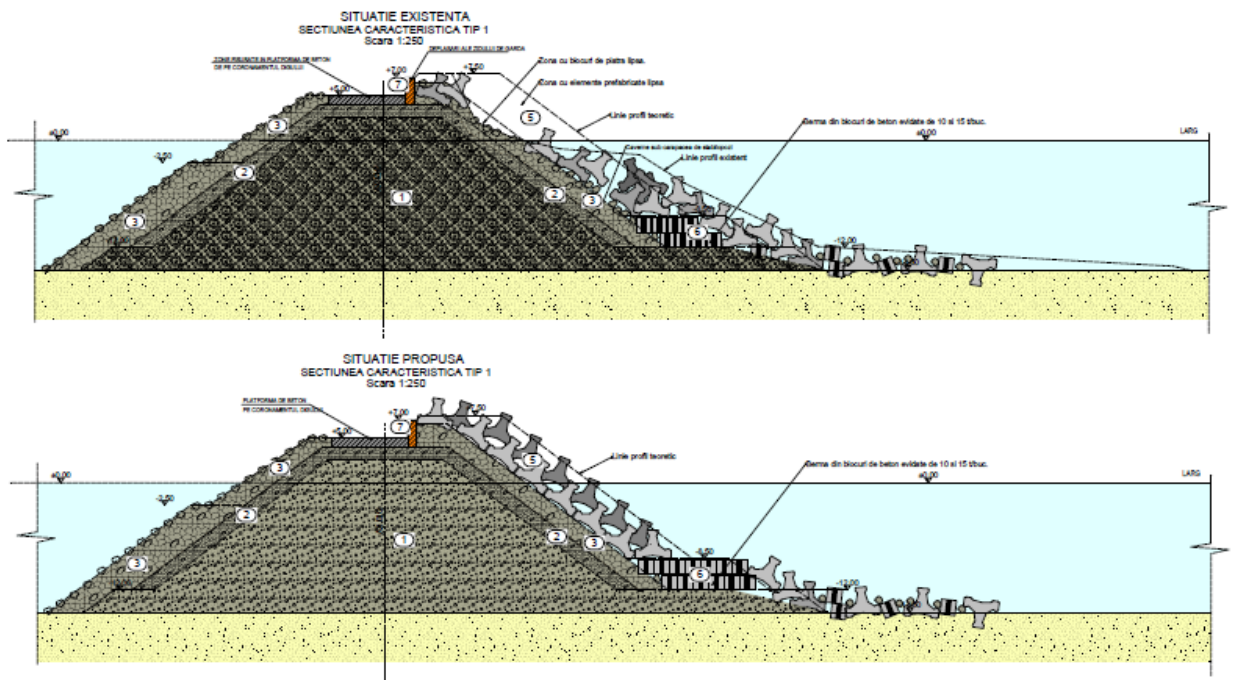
Sectiune caracteristica tip1 - situatie existenta si situatie propusa ( sursa. plansa 04 Allplan)
